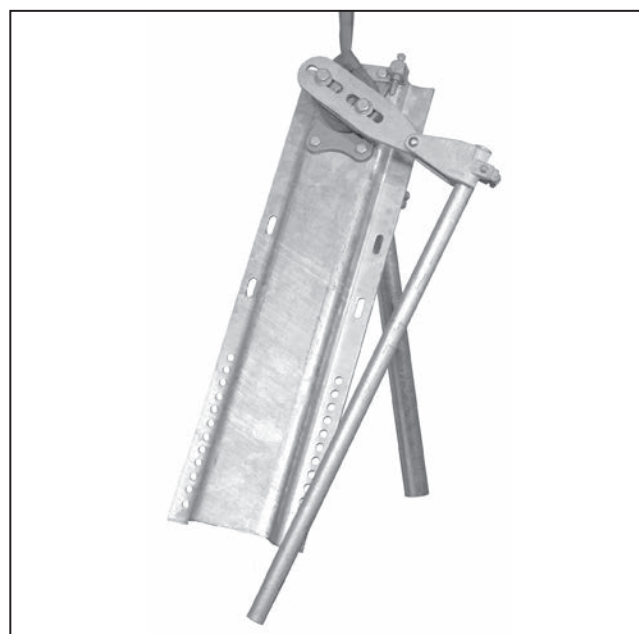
Faça o içamento do conjunto das ferragens de interligação até a posição.
